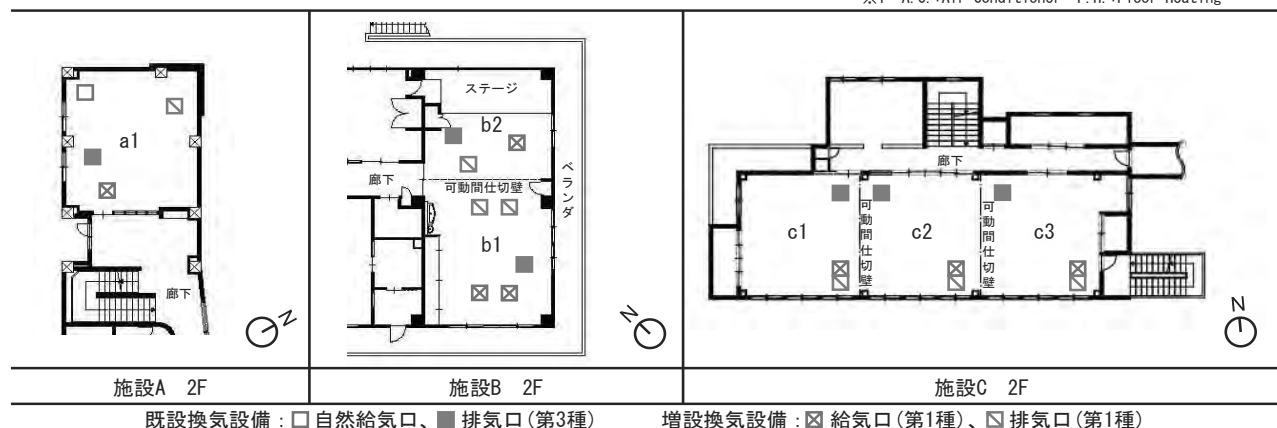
各施設平面図(1/400)と換気設備の位置及び種類
